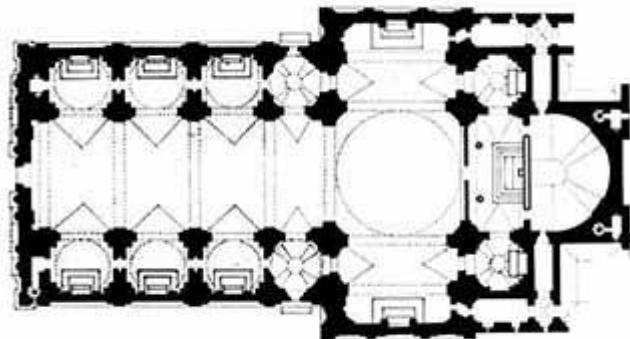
Grundriss, San Andrea della Valle, Rom.
